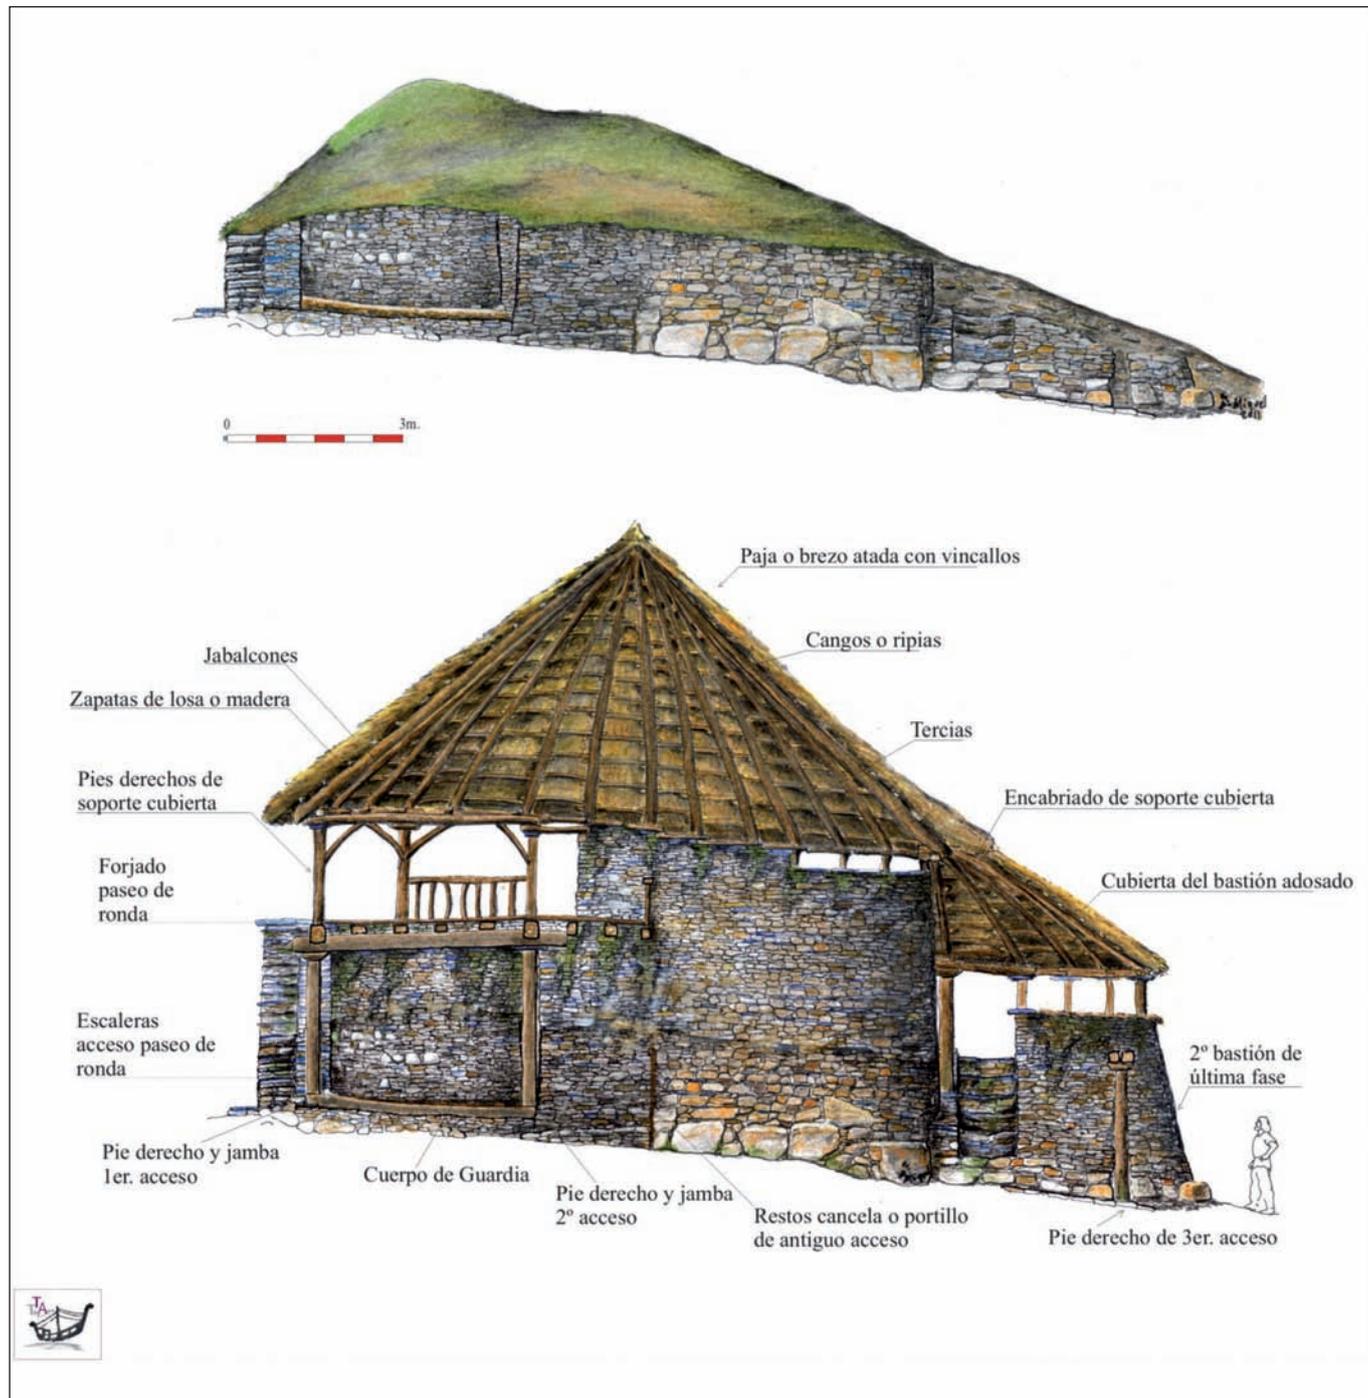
Alzado norte transversal y restitución hipotética de la entrada
